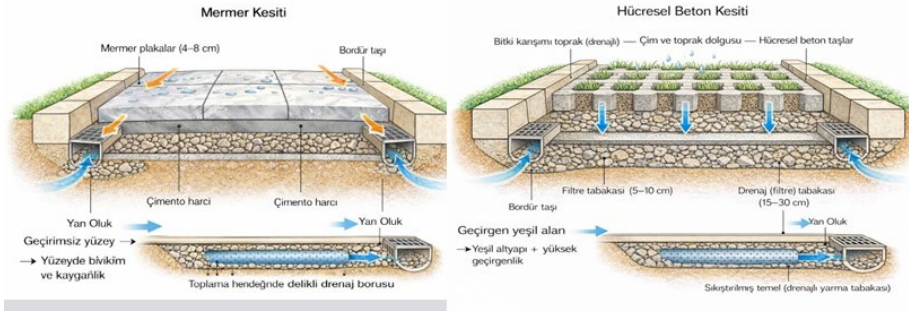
Geçirgen Beton Parke Kesiti ve Geçirimsiz Beton Kesiti (Orijinal, 2025).
